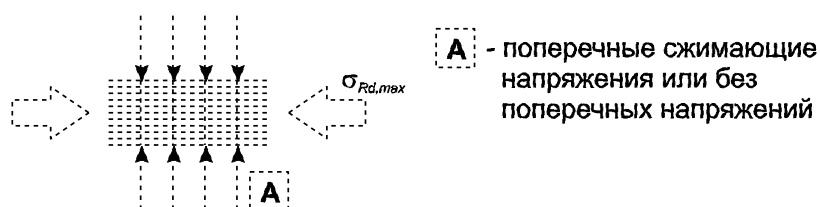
Расчет прочности бетонных распорок без поперечного растяжения
